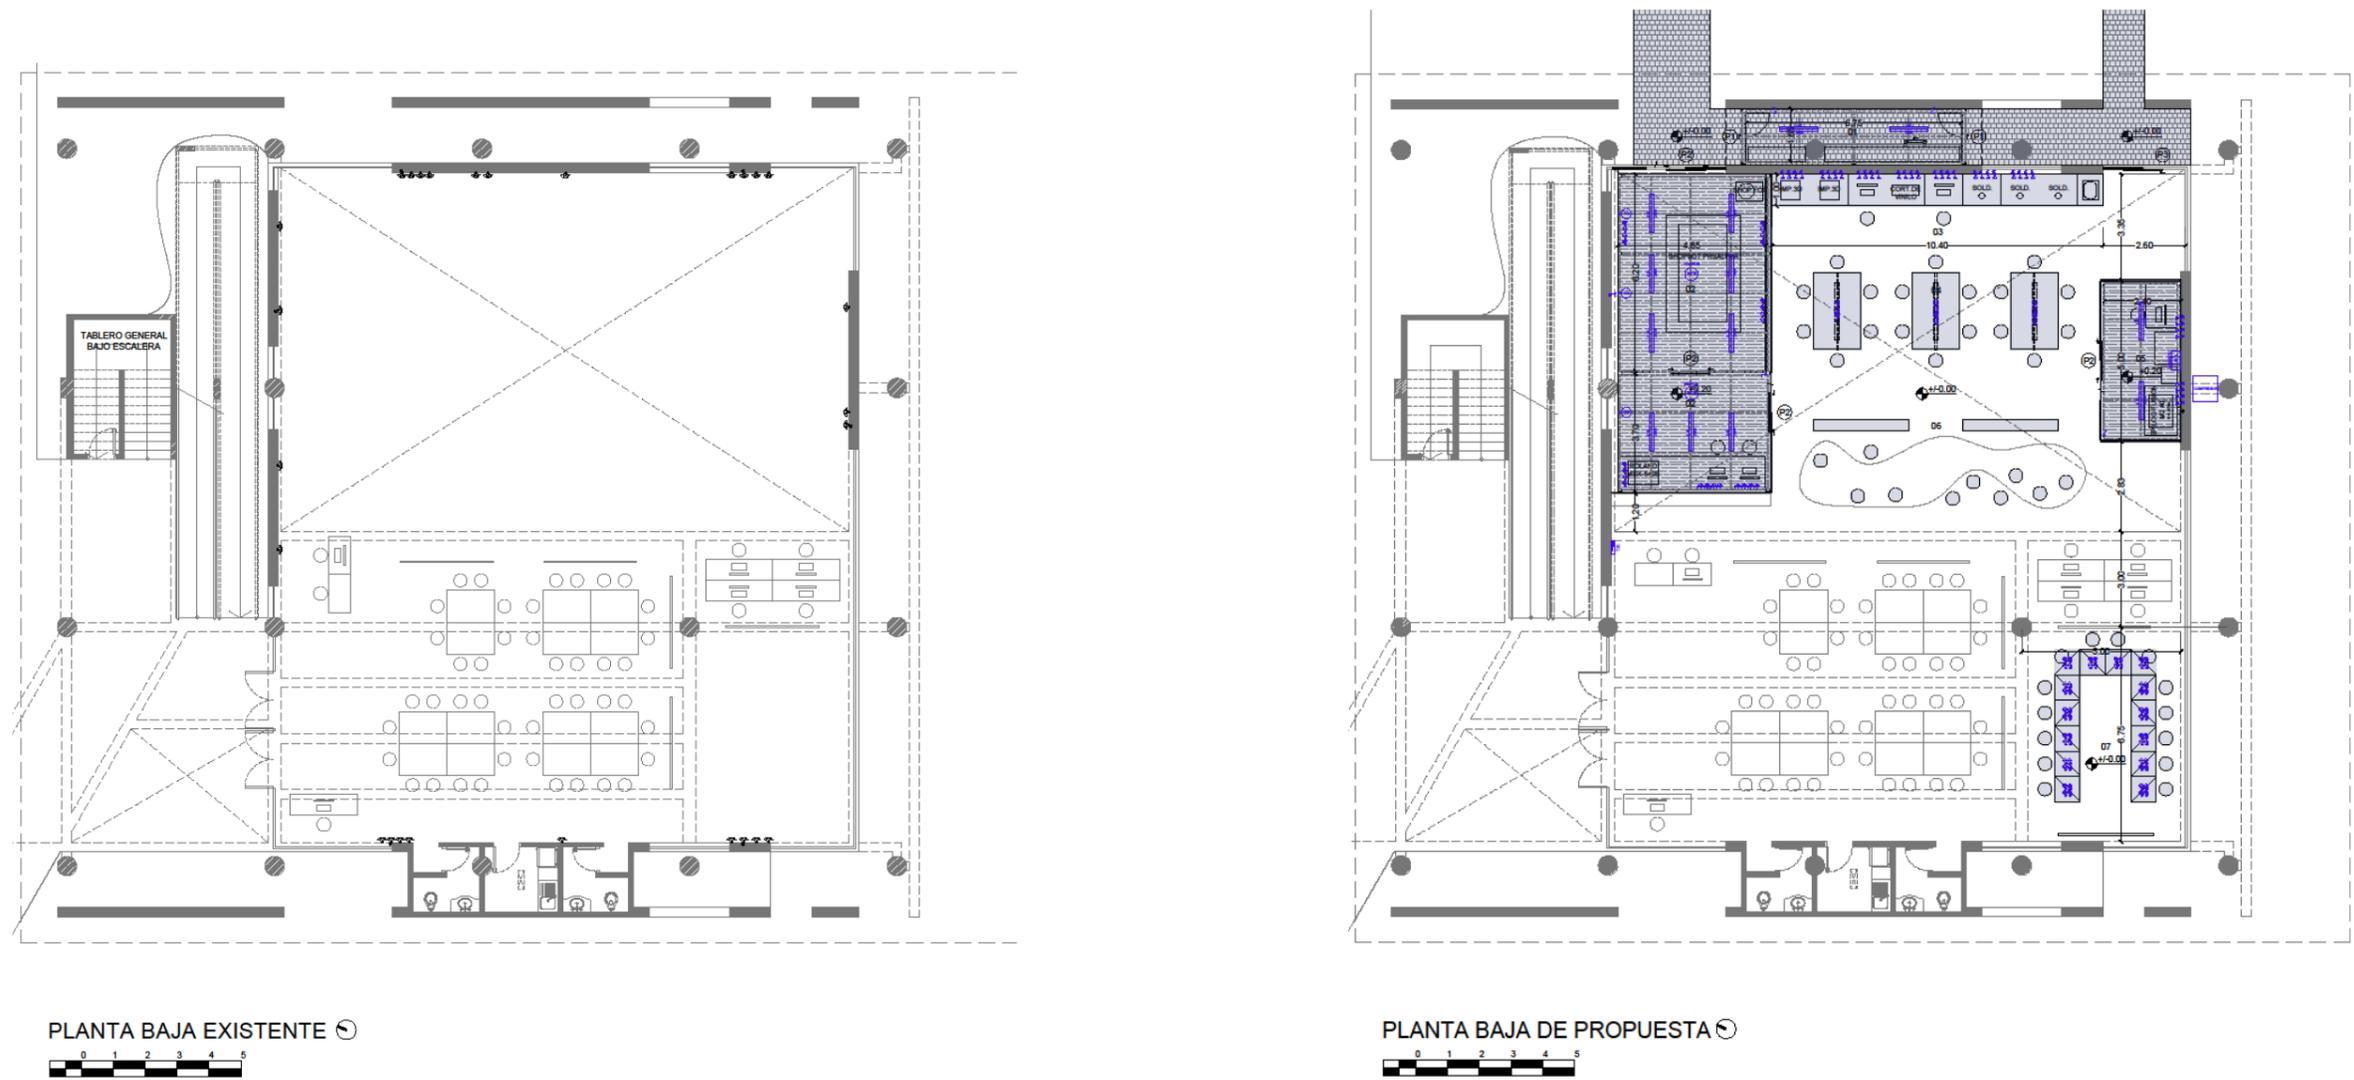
Planta baja existente y Planta baja de Propuesta. Elaboración propia.
